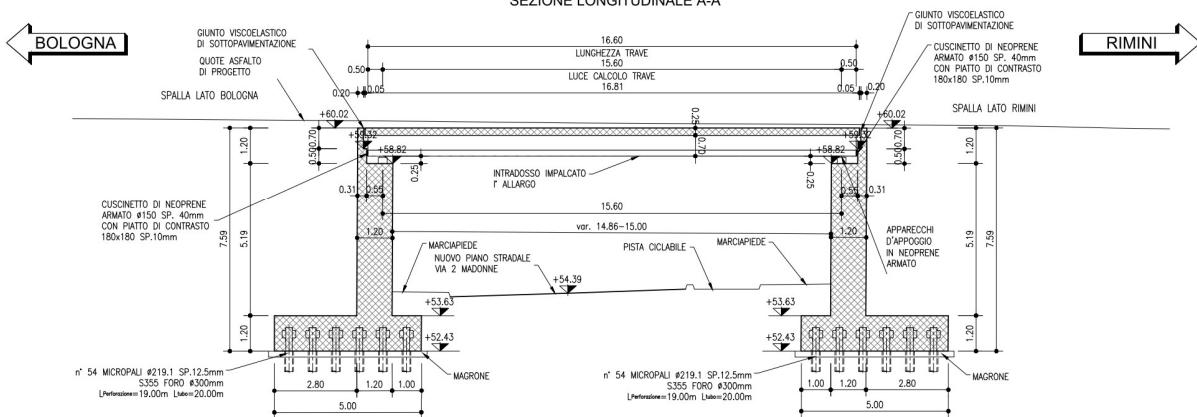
Sezioni longitudinali su II allargo – Carreggiata Sud
